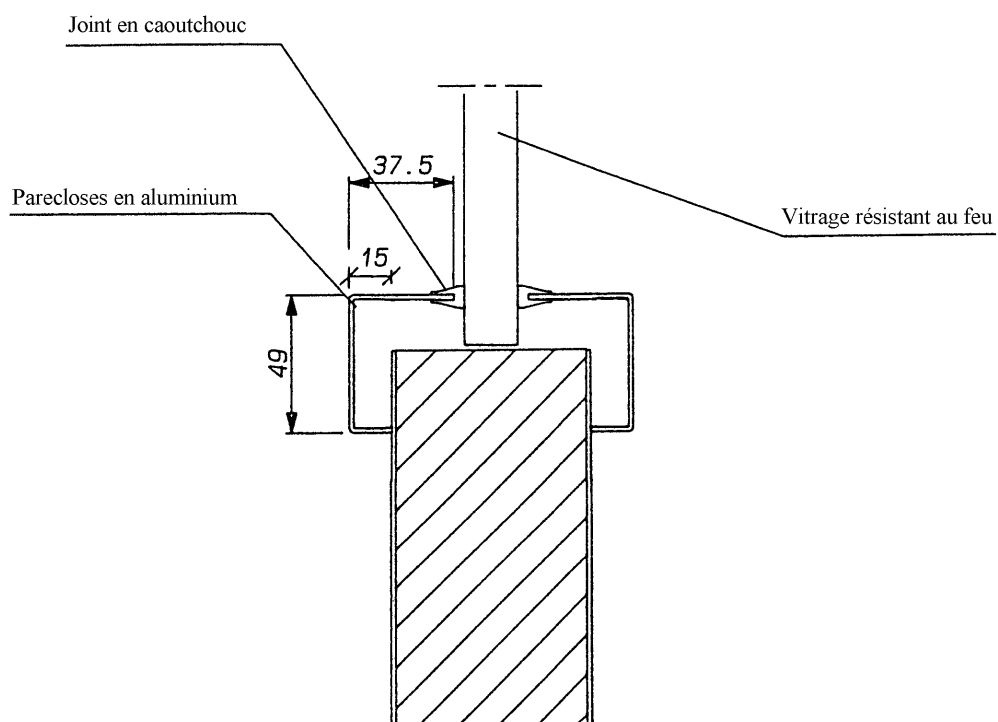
Coupe du vantail à l'endroit des pareclozes
